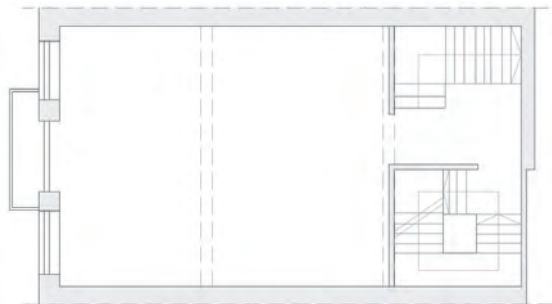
10. TERCERA PLANTA (BIBLIOTECA)
